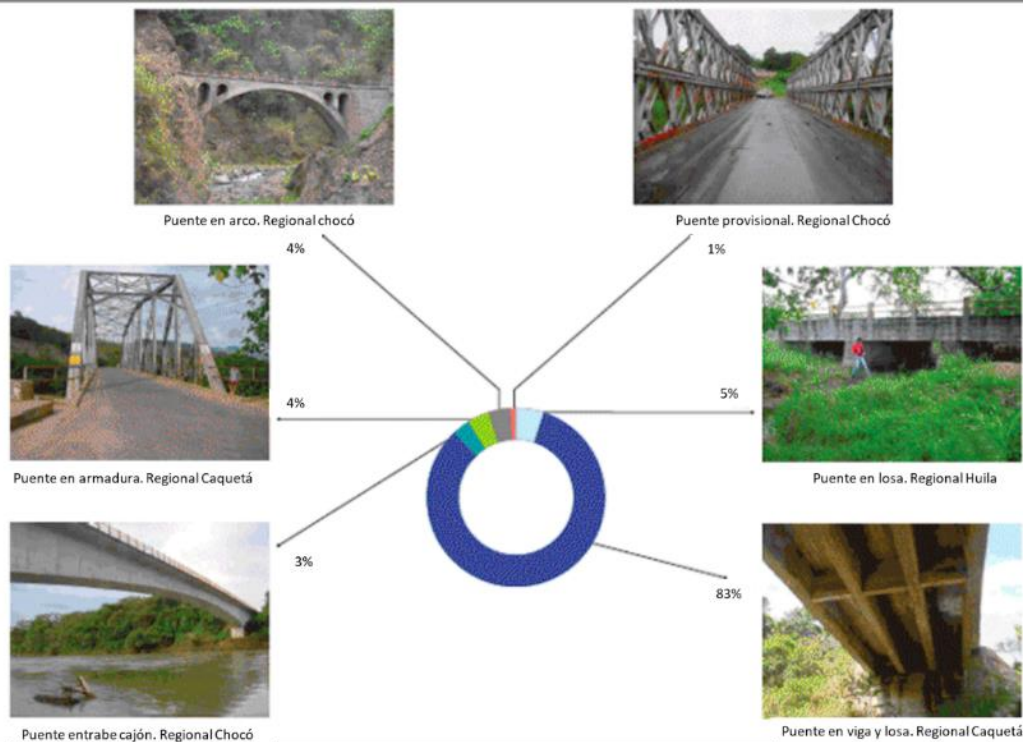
Distribución de las secciones transversales de la superestructura de los puentes de la red vial nacional.
